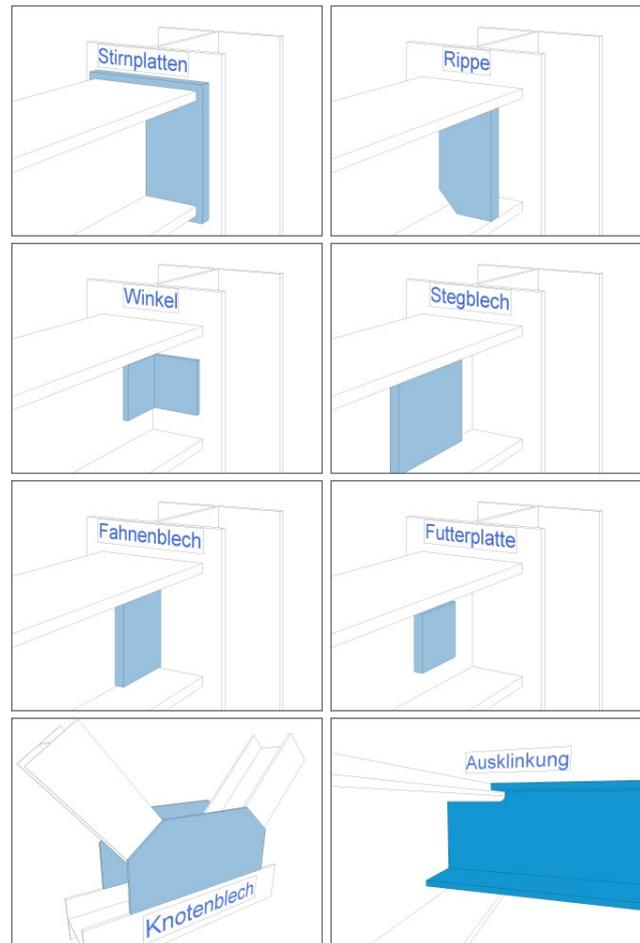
Übersicht „Stahlbau-Anschlüsse“
